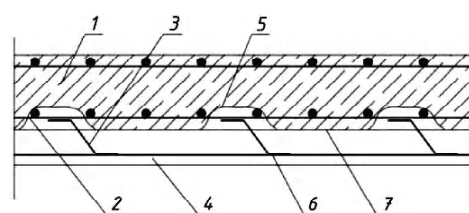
Нарастивание монолитного слоя снизу: 1 – усиваемая плита; 2 – рабочая арматура усиления; 3 – арматурные отгибы; 4 – торкретбетон; 5 – вырубленный защитный слой бетона; 6 – сварка; 7 – нижняя поверхность плиты, подготовленная к бетонированию.
